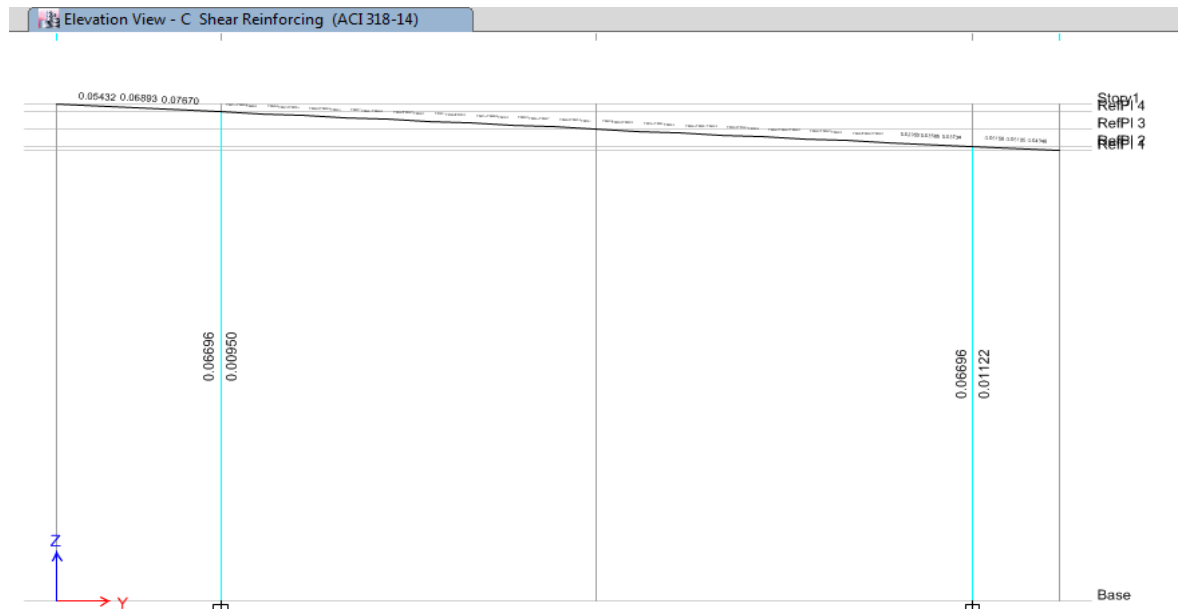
Área de acero por corte de viga (25X60) Módulo I
